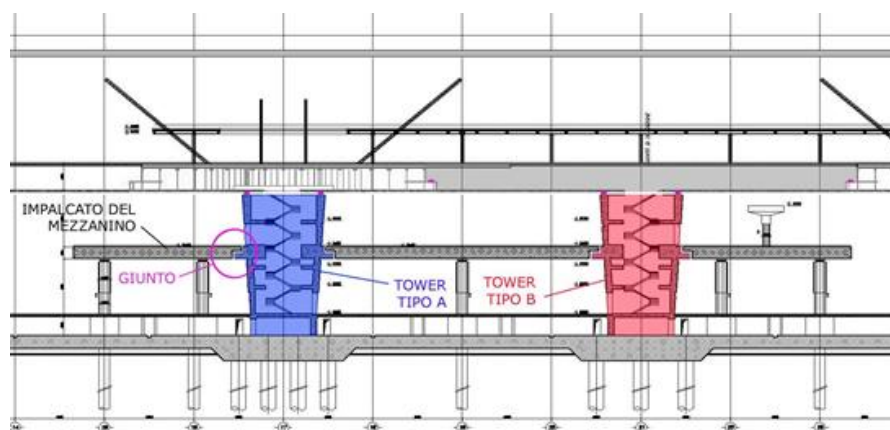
Sezione longitudinale tra i picchetti 14 e 24
